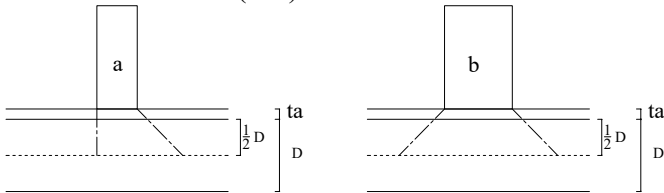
Geser Ponds Plat Dermaga Bagian Tengah
